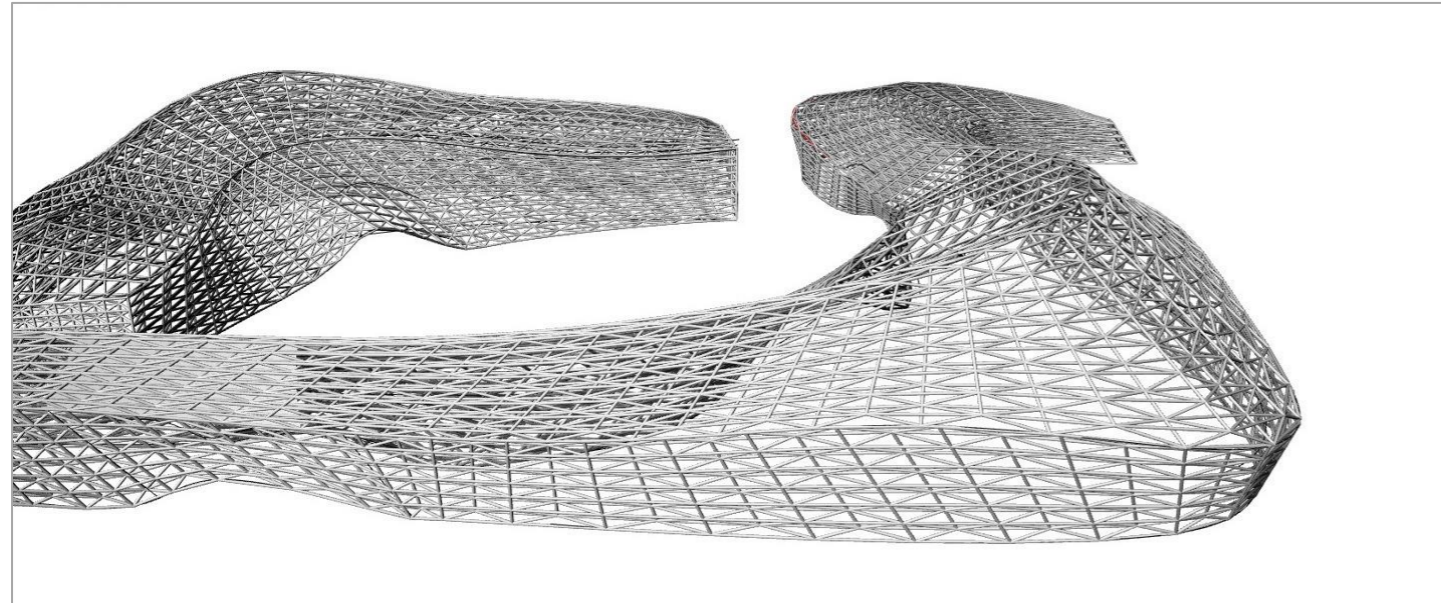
Schéma de la structure tridimensionnel de notre projet. Source : fait par l'auteur 2023
